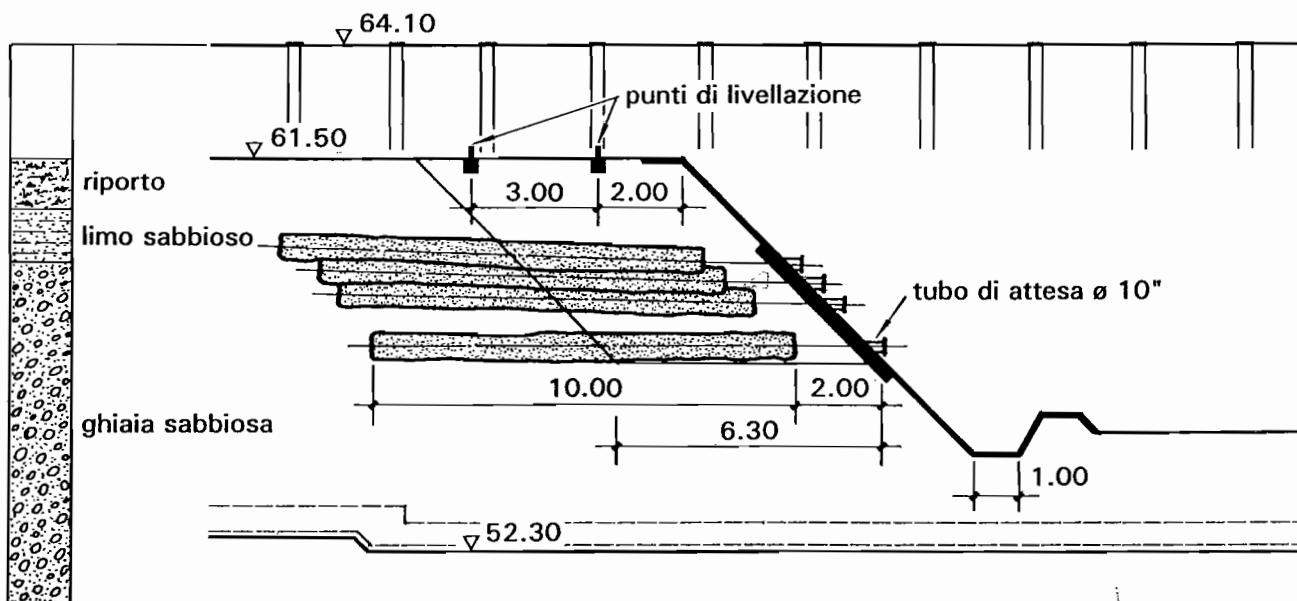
Campo prove preliminare. Schema delle colonne jet grouting.
